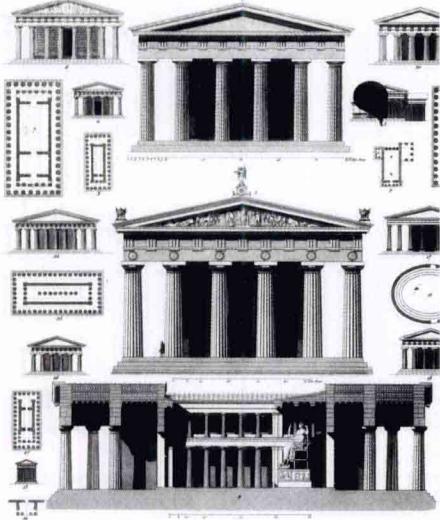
古代神殿的平面图与立面图，从图中我们可以看到平面造型与立体造型之间的联系，在建筑设计中平面思维与空间思维是密切相连的。
